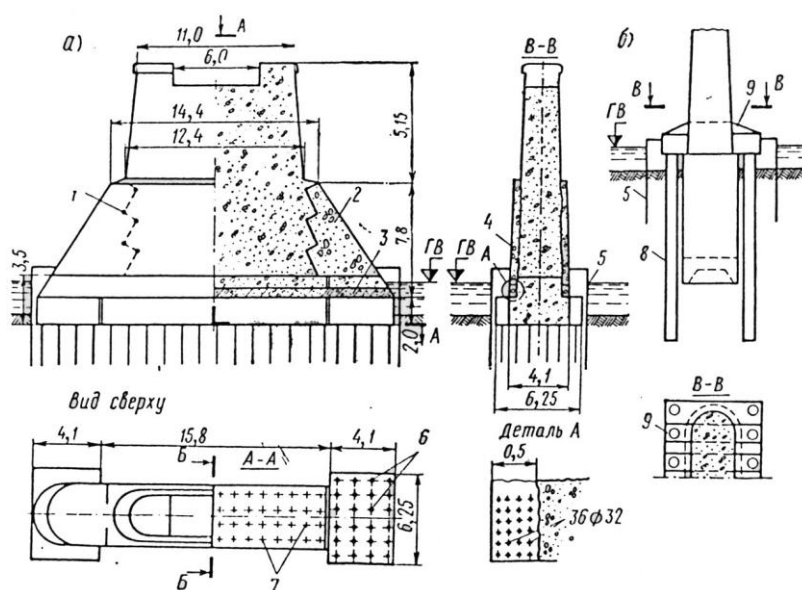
Усиление свайного фундамента опоры моста: 1 – инъекционные трубки; 2 – бетонный контрфорс (консоль); 3 – железобетонный пояс; 4 – оболочка; 5 – шпунтовое ограждение; 6 – новые сваи диаметром 60 см; 7 – существующие сваи сечением 30х30 см; 8 – буровые сваи; 9 – железобетонные балки
